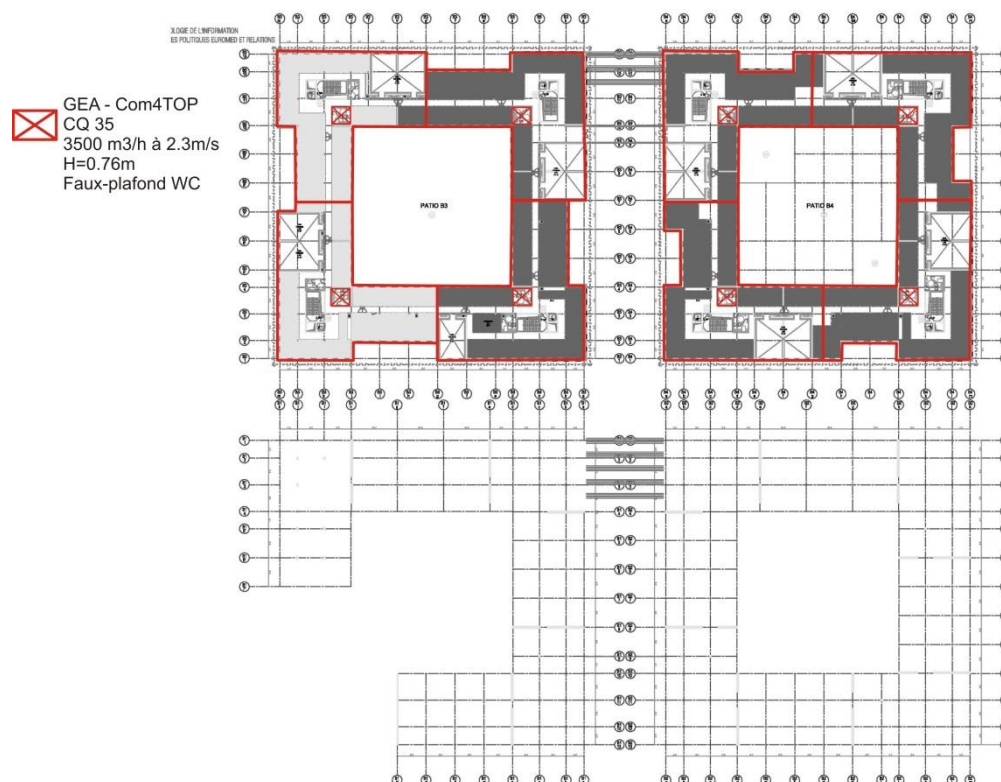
Plan d'implantation des CTA – B3B4 R3
